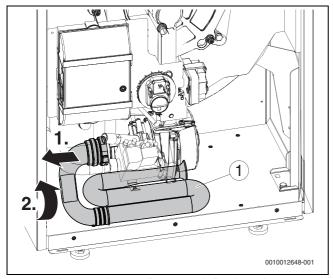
Démontage du tuyau d'aspiration de l'air de combustion
